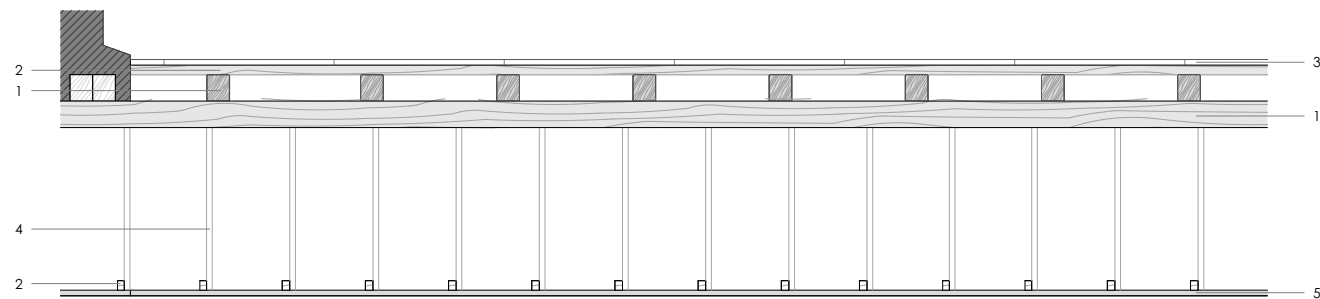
Detalle constructivo 31 | Estado actual entrepiso, espacio: dormitorio.
